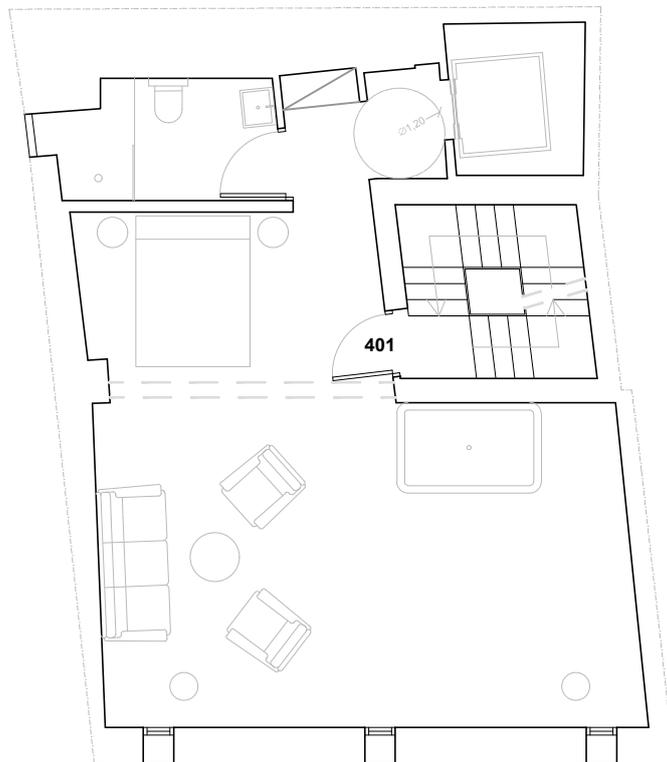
Planta Cuarta / Bajo Cubierta Edificio Propuesta, Fuente: Elaboración Propia
